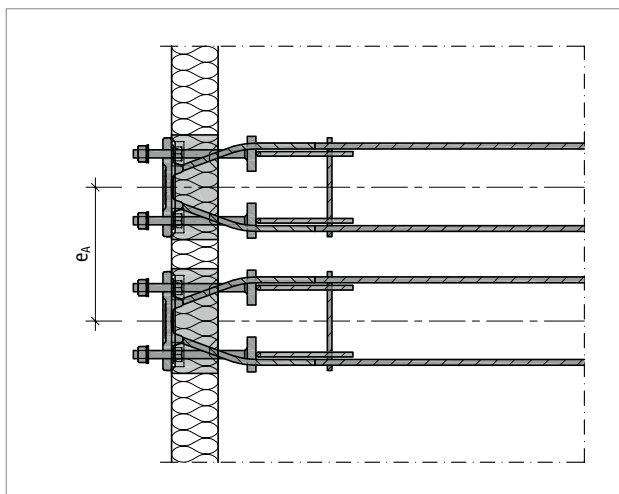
Schöck Isokorb® T type SQ : espacement axial
